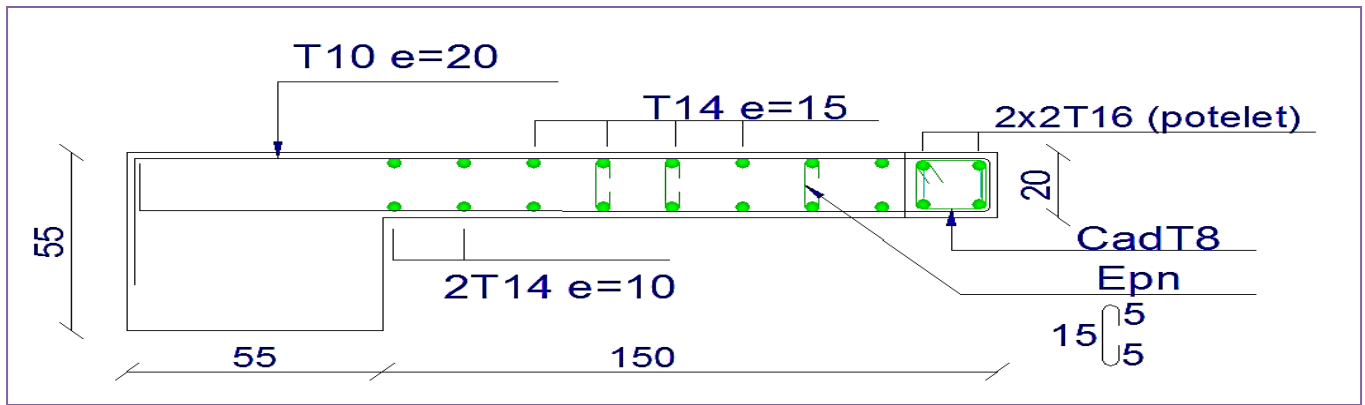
Schéma de ferrailage des voiles type V2 zone 1.
